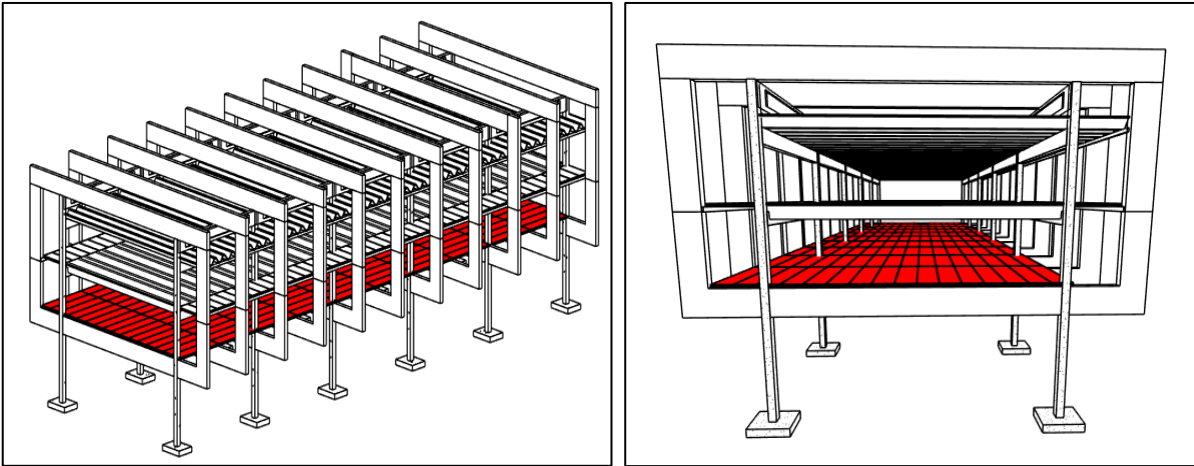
Ubicación de losas en entrespiso sobre planta baja (en rojo). Fuente: Autor.
